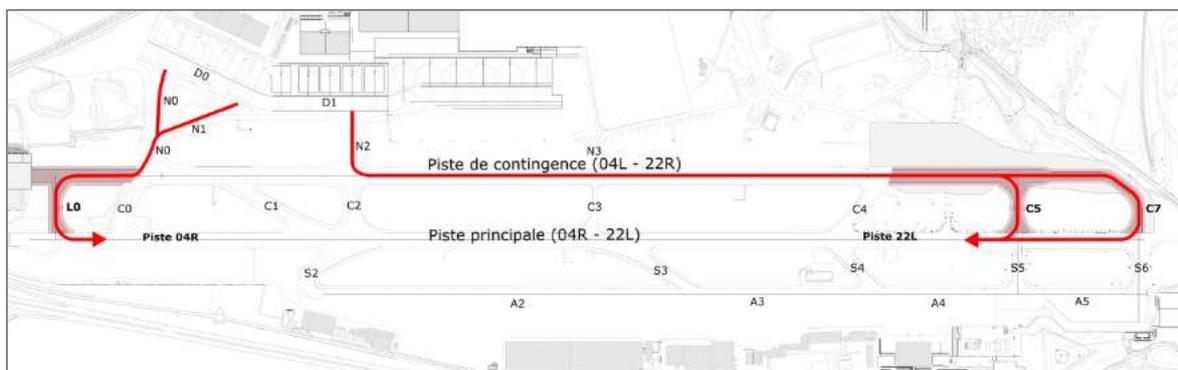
Nouvelles manœuvres d'accès aux pistes 22L et 04R depuis la zone fret nord (ARIES sur fond de plan GREISCH, 2020)
